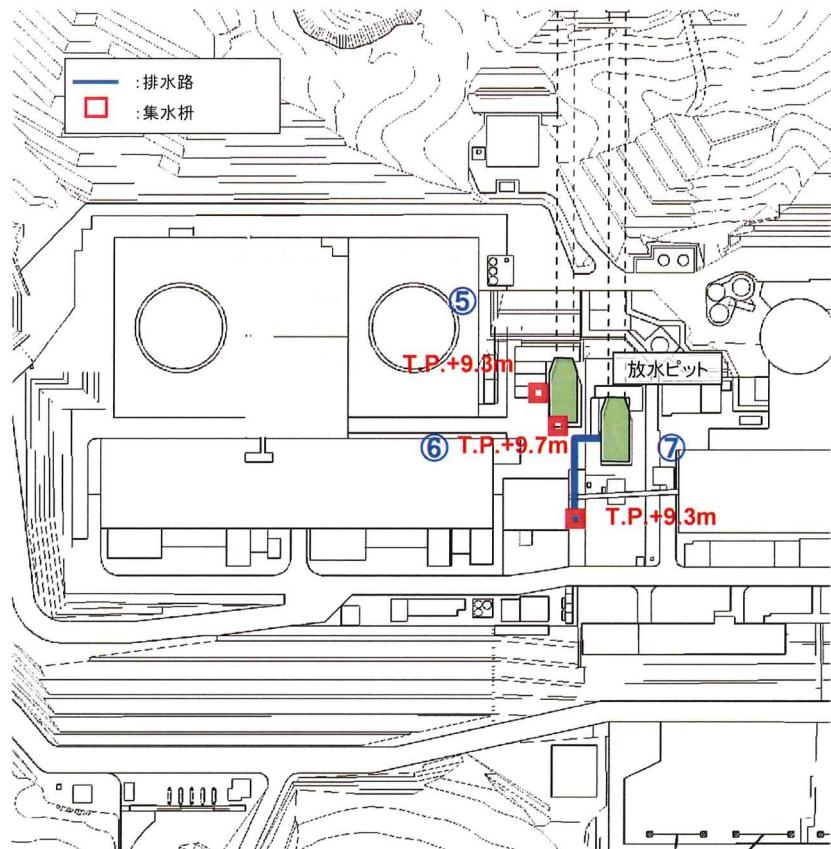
屋外排水路配置図（放水ピット周辺）
